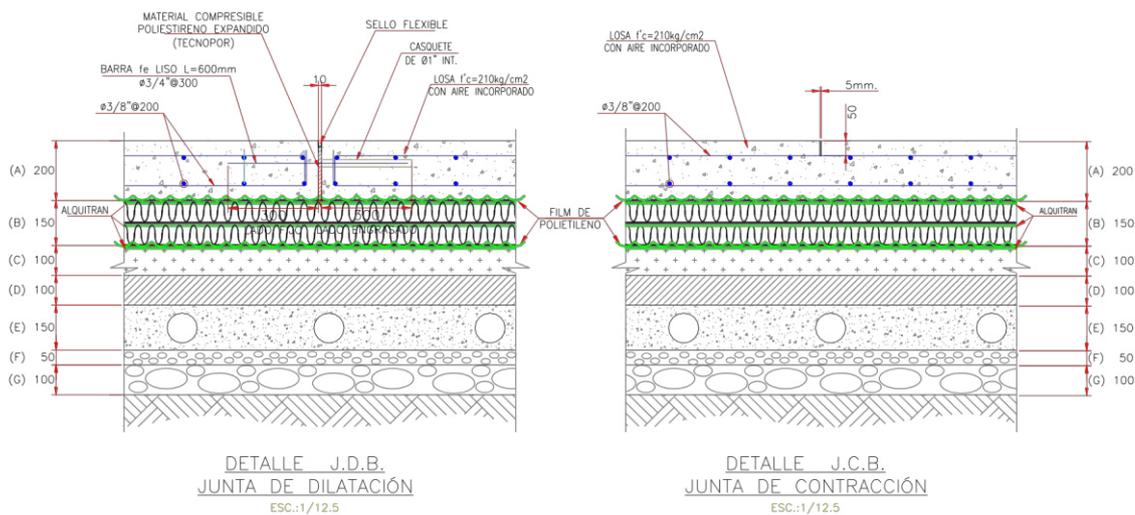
Detalle de Losa en piso de Cámara de Congelado
